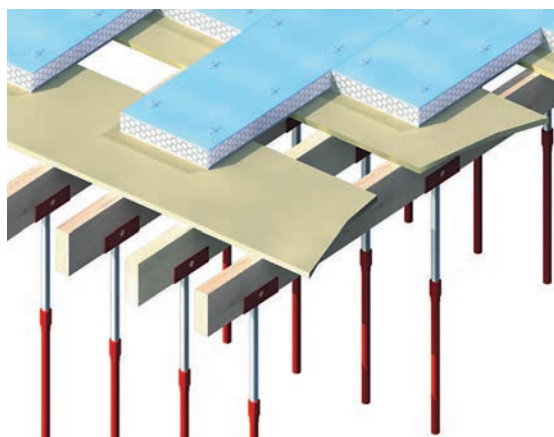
Mise en place des panneaux en coffrage isolant traditionnel
